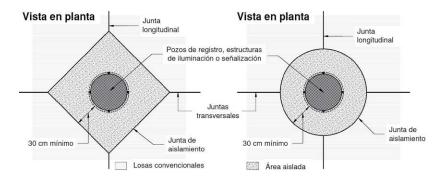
Esquemas constructivos de las juntas de aislamiento para pozo de registro y estructuras de iluminación o señalización vertical Fuente: Adaptado de la Guía básica de juntas para pavimentos de concreto.
